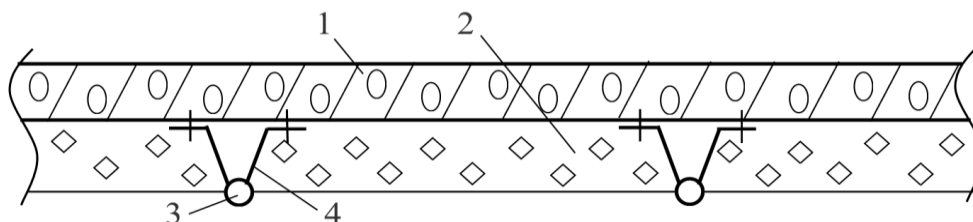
Взрывоустойчивое межэтажное перекрытие автостоянки: 1 – железобетонная основа перекрытия; 2 – амортизирующий слой; 3 – силовая труба; 4 – листовое основание каркаса
